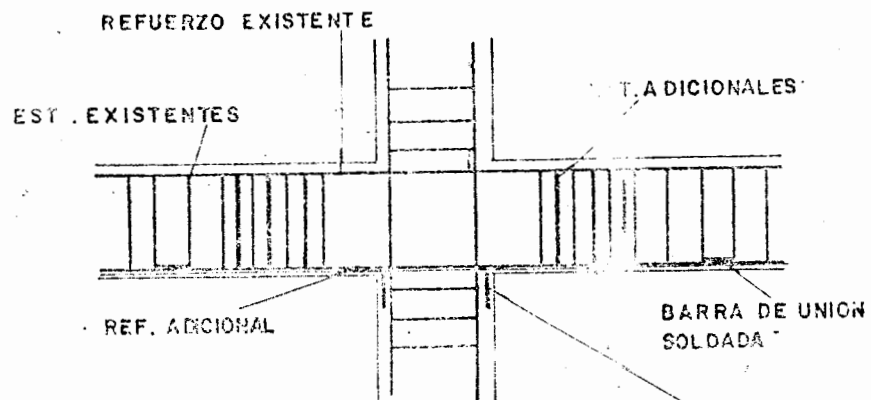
ENCAMISADO DE UNA VIGA CON CONCRETO REFORZADO POR FLEXION.
